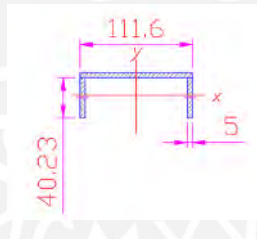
Dimensiones de la sección del perfil estructural viga "U"
